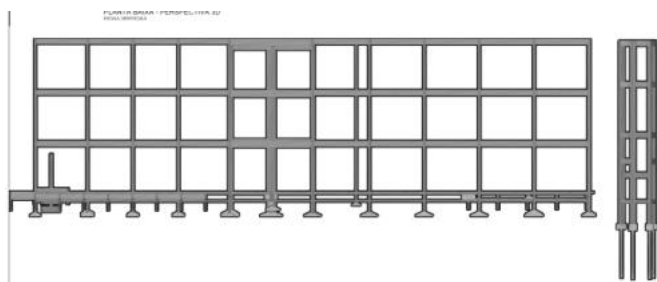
Fundações do tipo Sapata isolada, para prédio principal e Bloco de coroamento com estacas escadas para torre;
